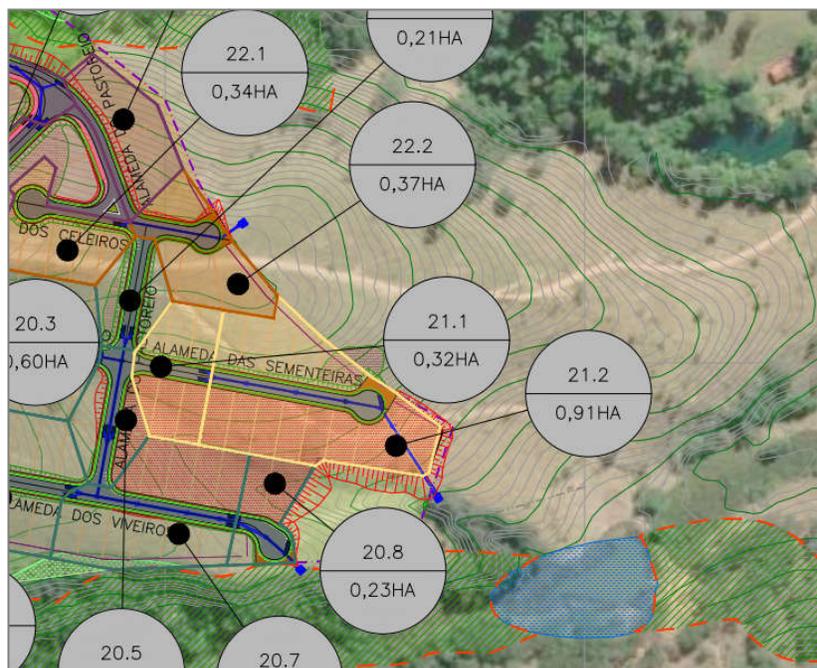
Recorte de trecho do projeto de drenagem, exemplificando trecho do projeto de drenagem proposto para o loteamento, com destaque para pontos de lançamento final próximo corpos d'água e caminhamento de rede em área de lote. Fonte: Processo nº 4359/2022.
